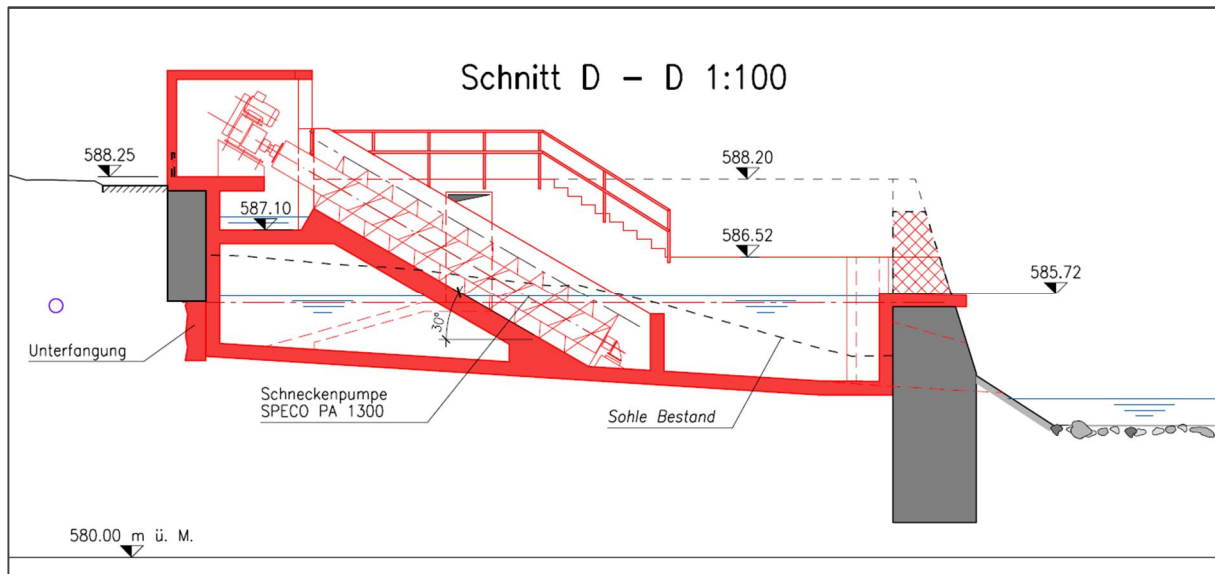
LÄNGSSCHNITT DURCH SCHNECKENPUMPE INNERHALB SANDFANG MÜLLERSCHWELLE
